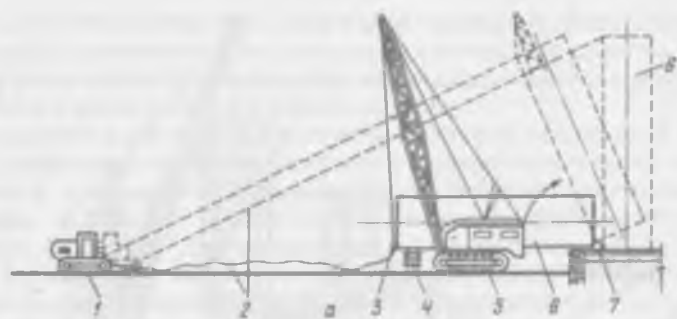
Монтаж металлического каркаса надстройки рабочего здания РЭС-6х175 укрупненными блоками
